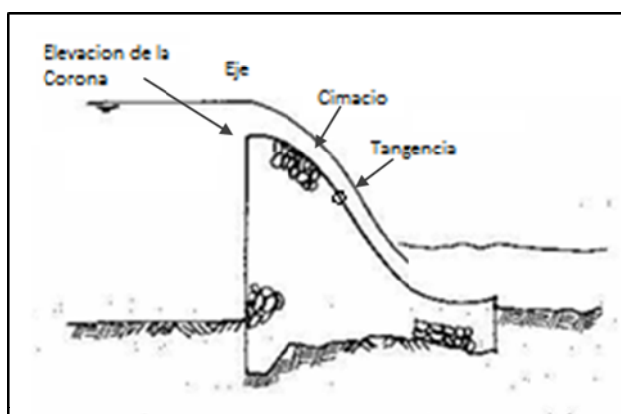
Sección típica de cortina vertedora rígida (modificado de Vega O. Arreguín, 1987)
